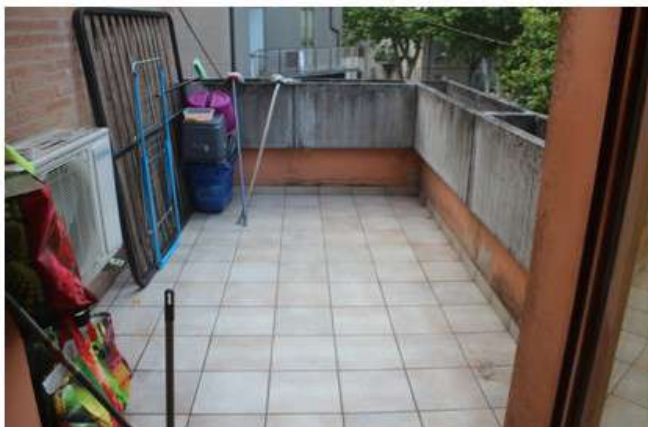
balcone: vista verso l'esterno e verso l'ingresso
